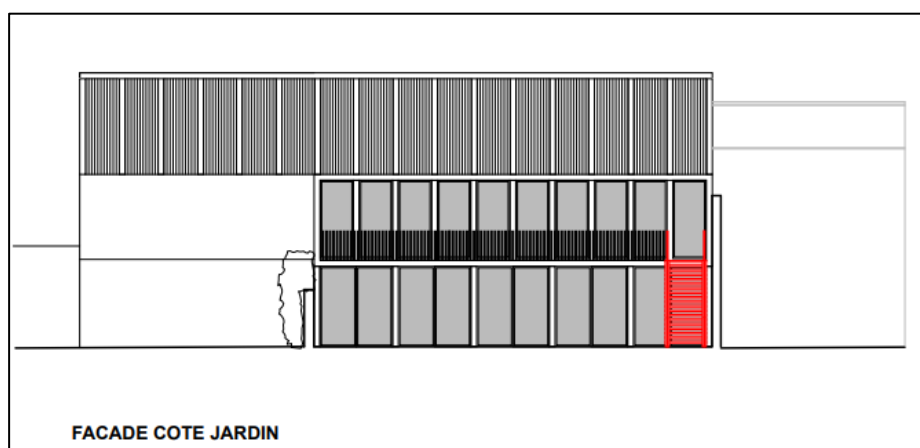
Façade côté jardin du projet en zone 2 (orange)
